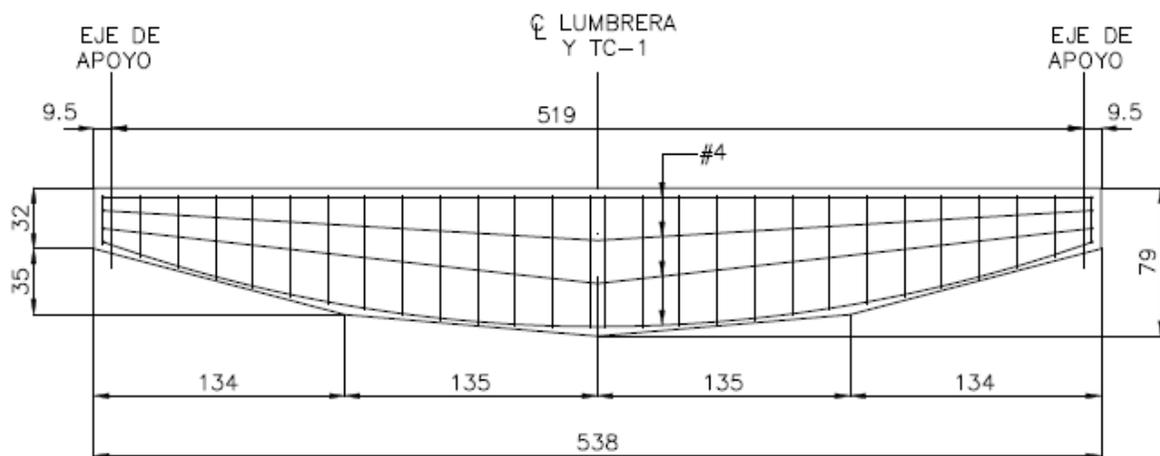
Detalle 3. Acero de refuerzo en trabe de cierre TC-1.
